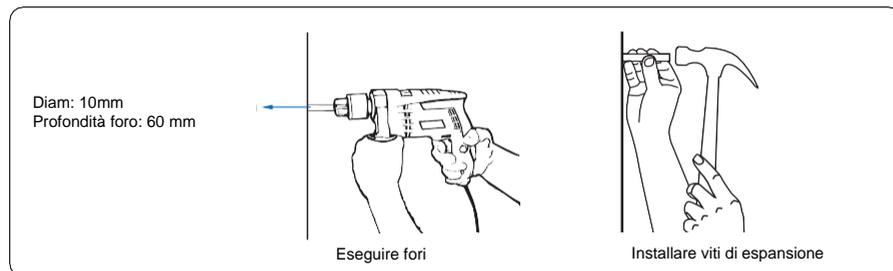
Perforare i fori e installare l'espansione (unit: mm)
